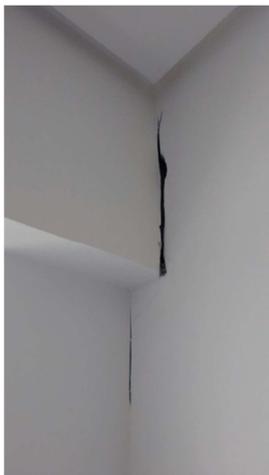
Manifestação de fissuras no revestimento de parede
